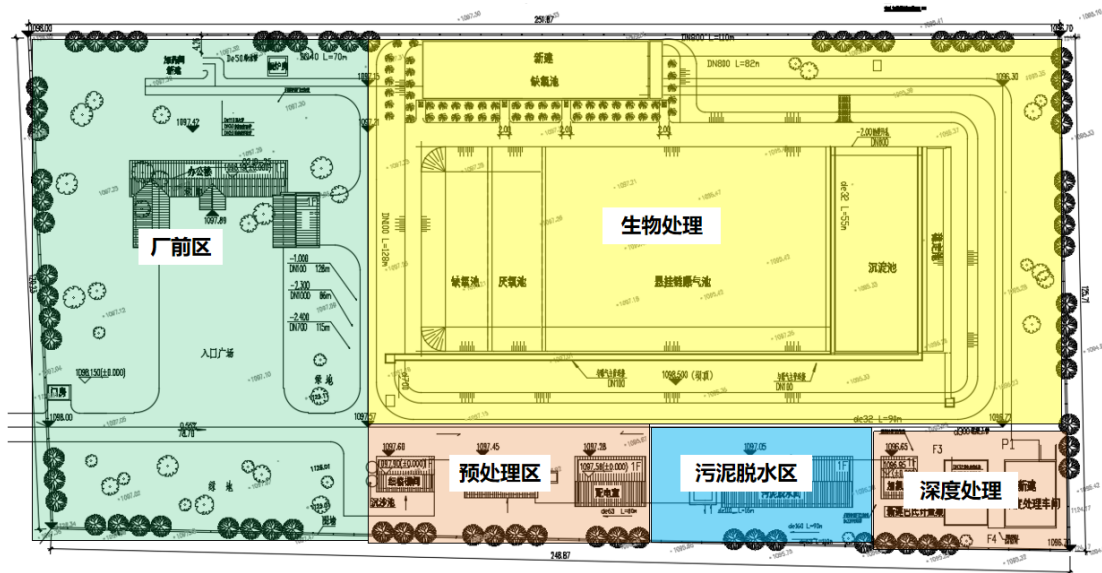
吴忠市第二污水厂现状总平面图布置
